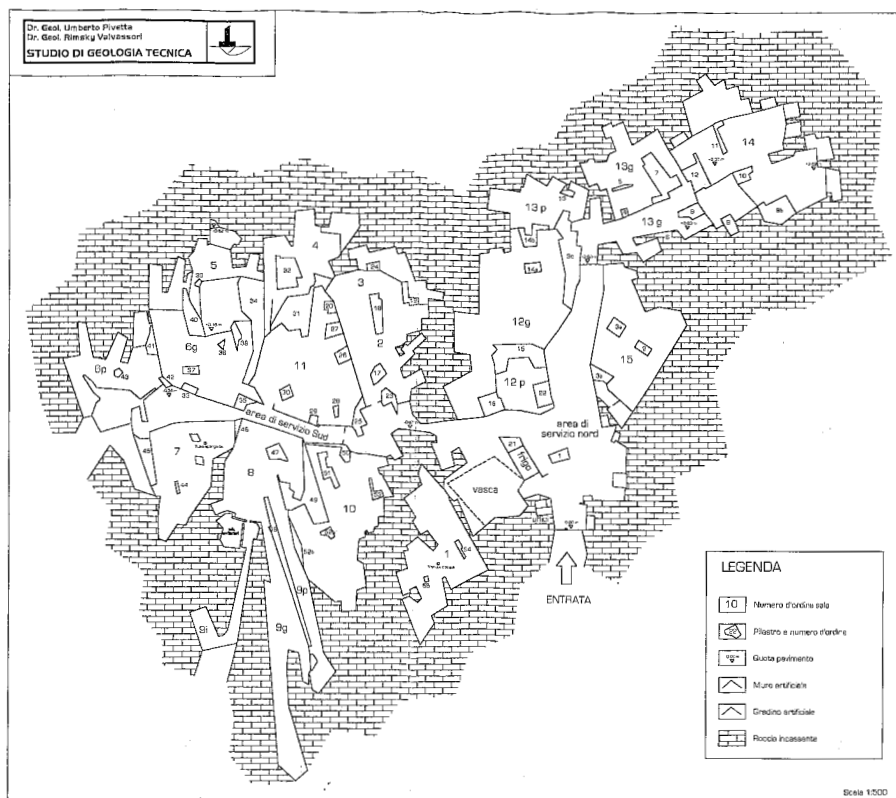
Planimetria degli spazi sotterranei del “Covo della Guerra” di Costozza di Longare.
